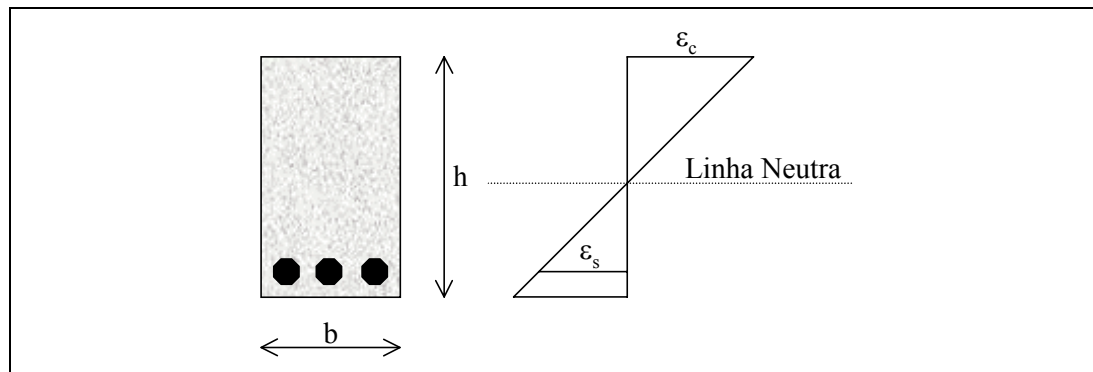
Distribuição linear de deformações em viga de concreto armado
